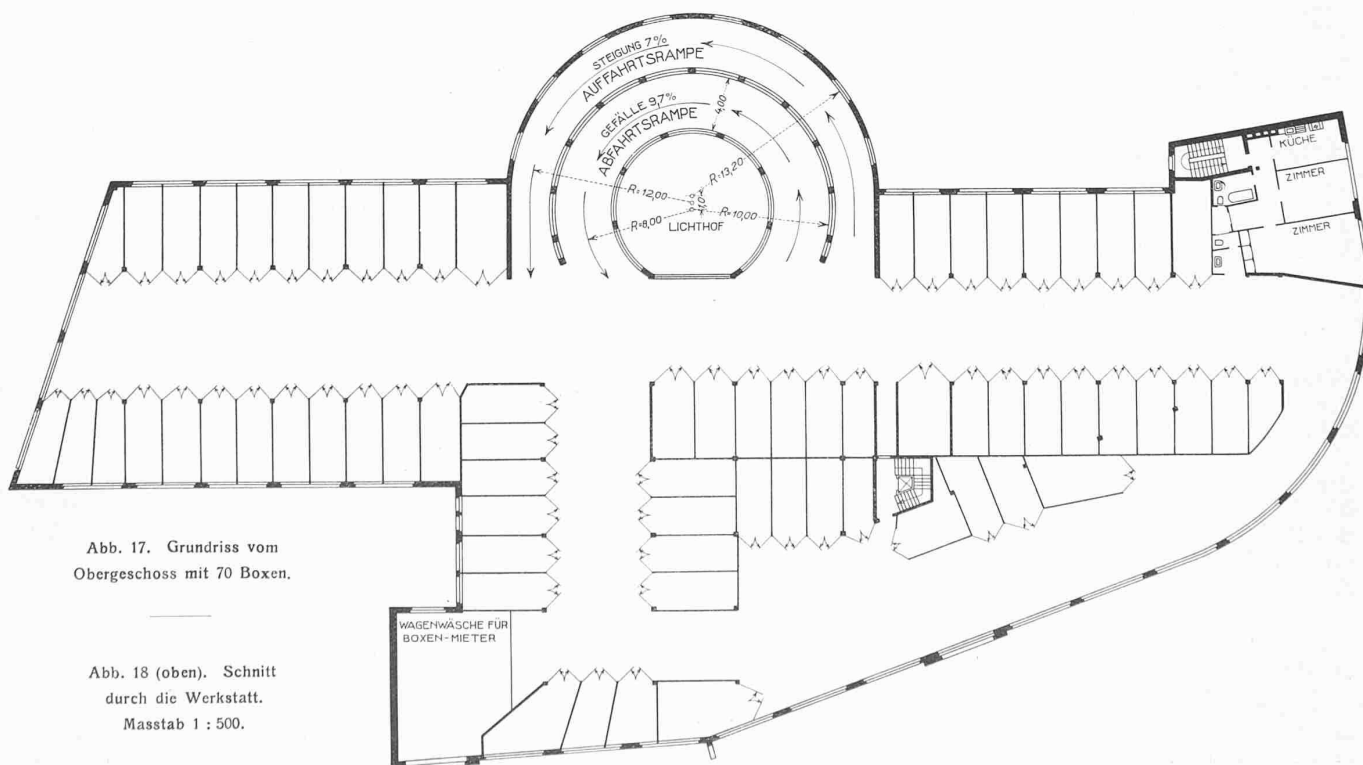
Grundriss vom Obergeschoss mit 70 Boxen.
